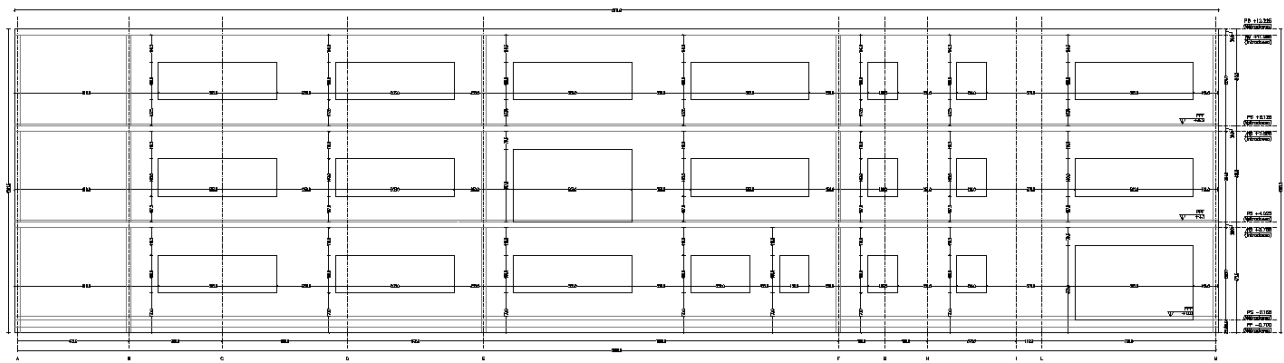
Prospetto sud-ovest setti scuola: strutture in progetto
